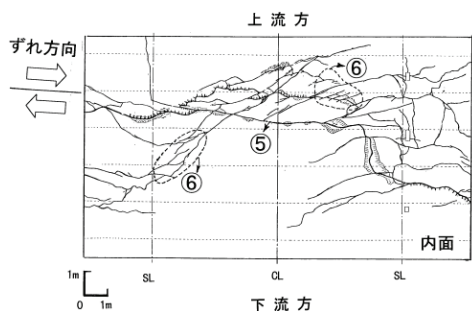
実際のひび割れ展開図<sup>5)</sup>
